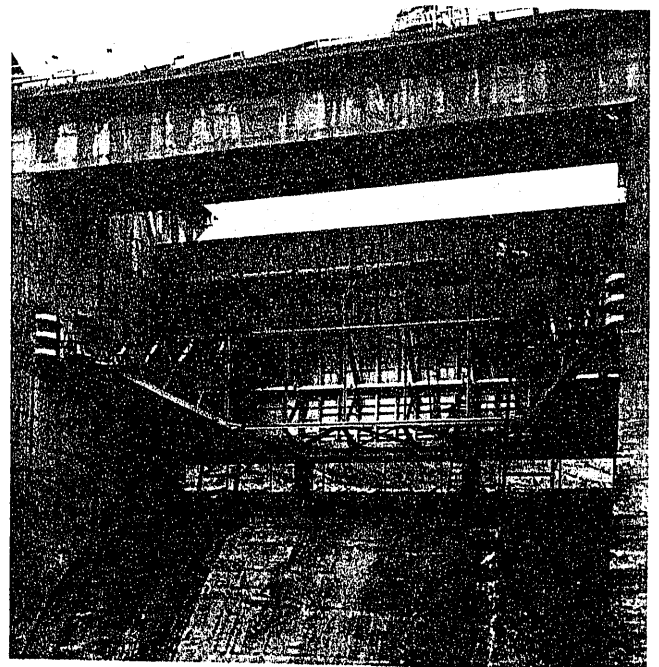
Salto de Villalcampo. Compuertas. Montaje de los refuerzos en la estructura existente.
